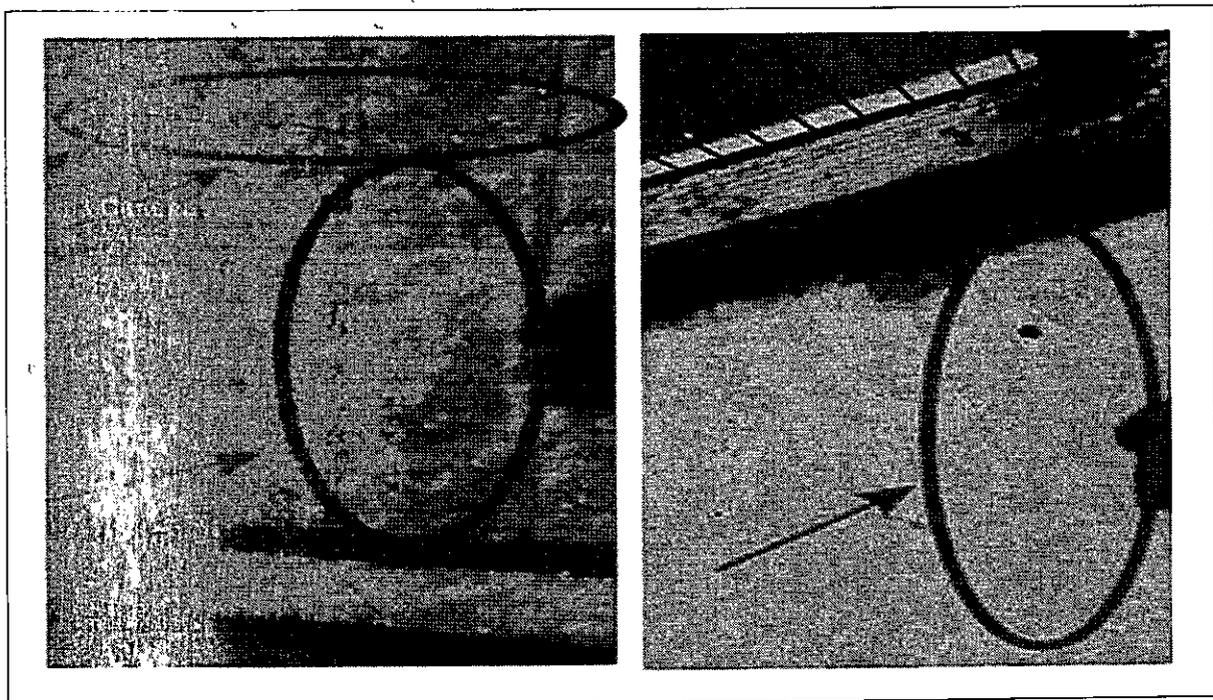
Cancha multifuncional el campestre 5 etapa, fisuras encontradas
